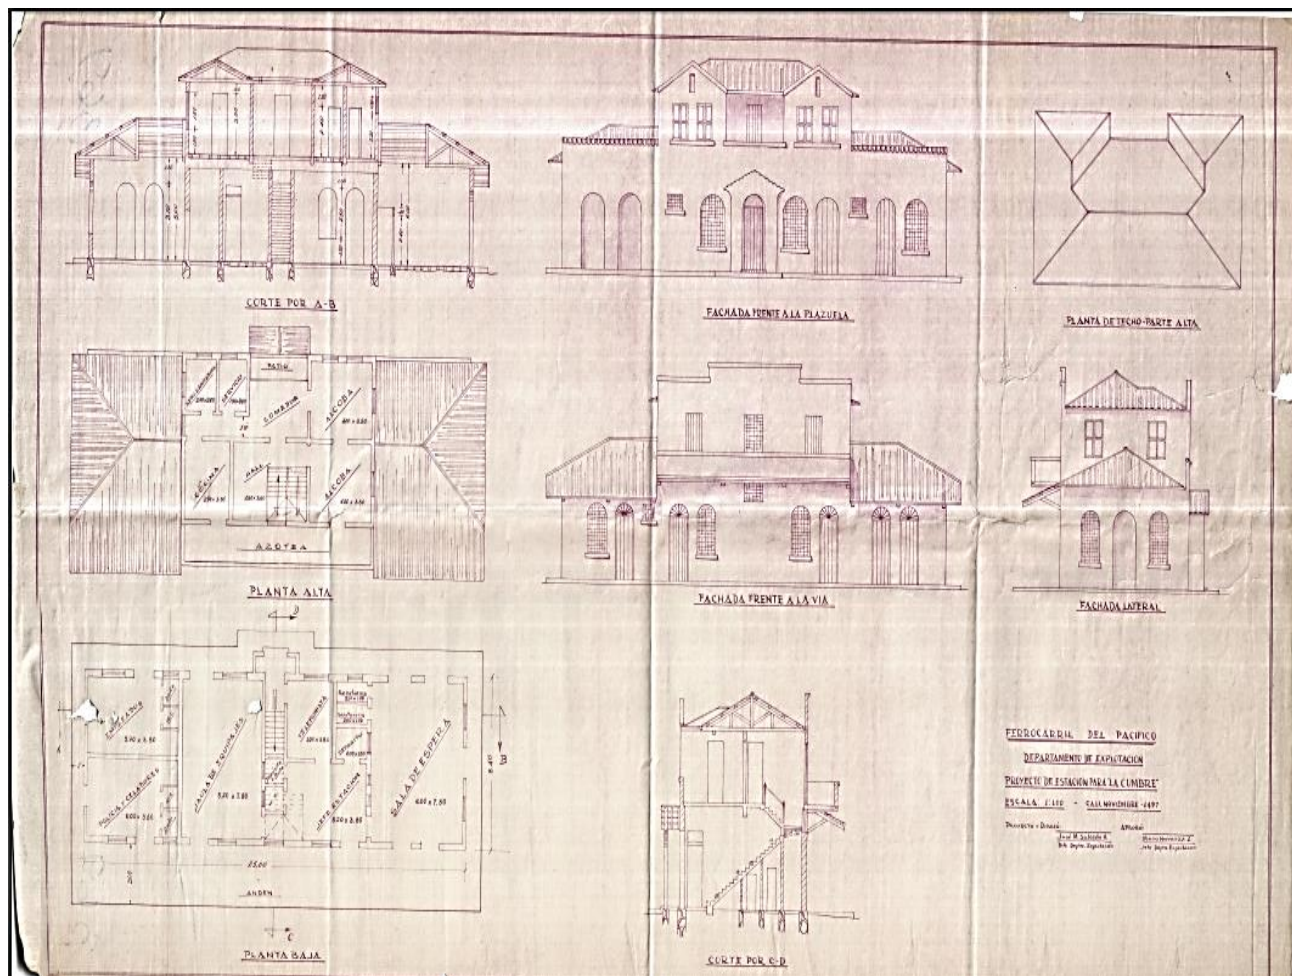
Plano Arquitectónico: Proyecto de Estación para La Cumbre.
